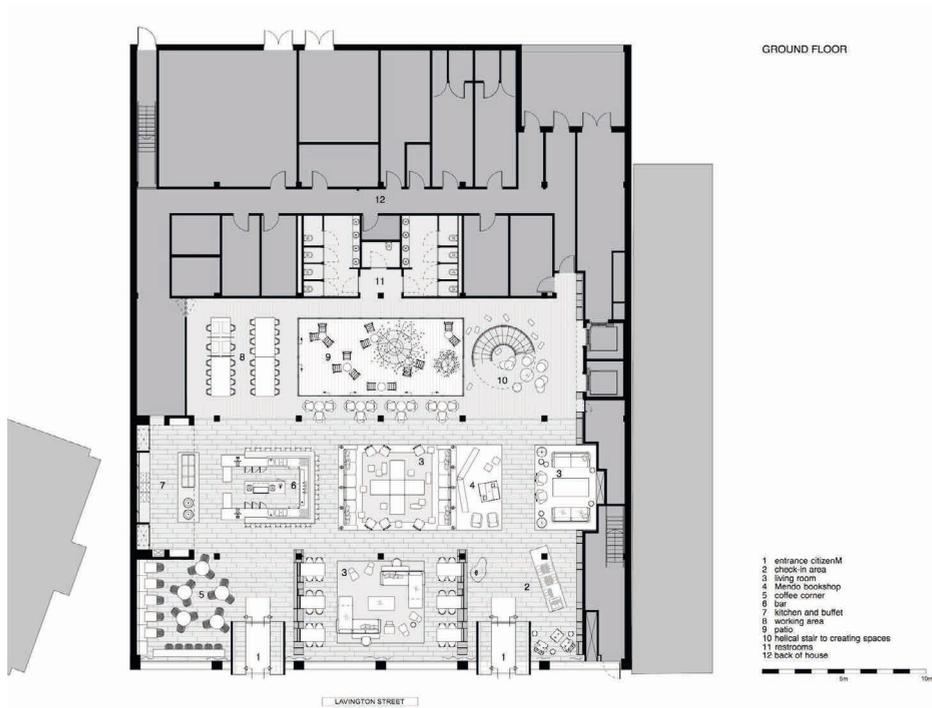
; Grundriss Erdgeschoß, CitizenM, London - Concrete Architecture
